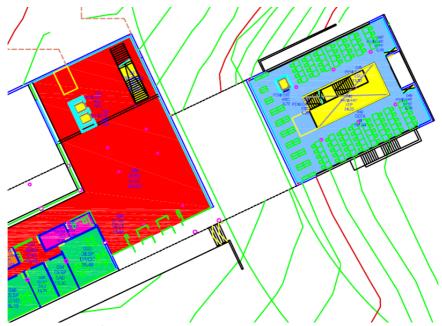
Detalle de la planta entreplanta de la Biblioteca
